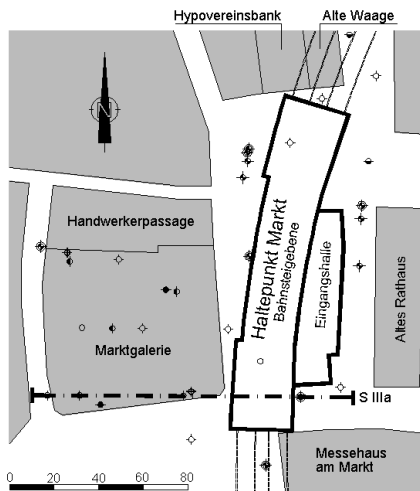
Lageplan Haltepunkt Markt mit Aufschlusspunkten, einschließlich jener der Marktgalerie
